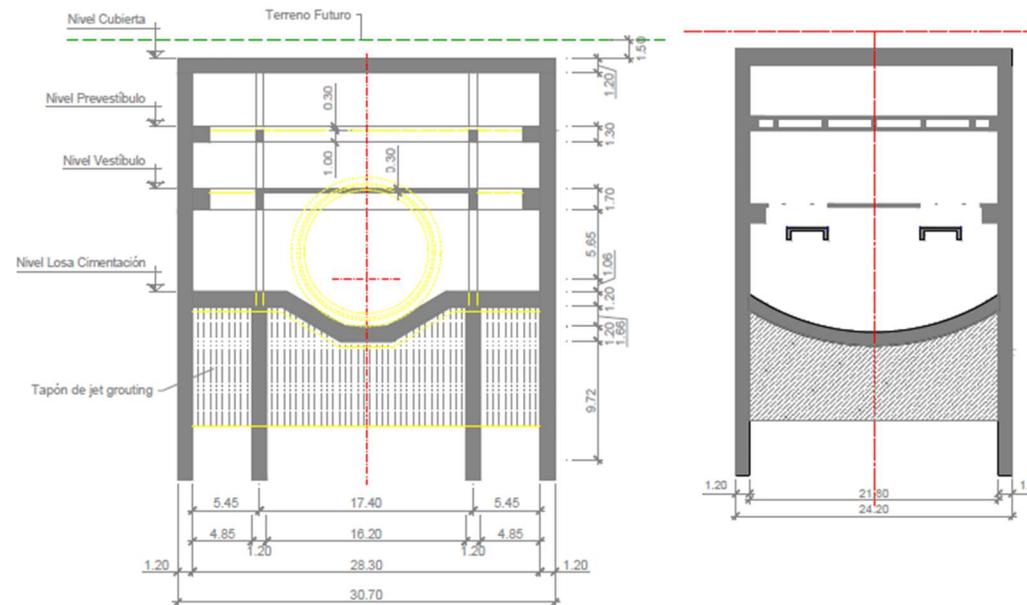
Sección tipo para estación en túnel con tuneladora. Fuente: Metro de Bogotá, 2015
